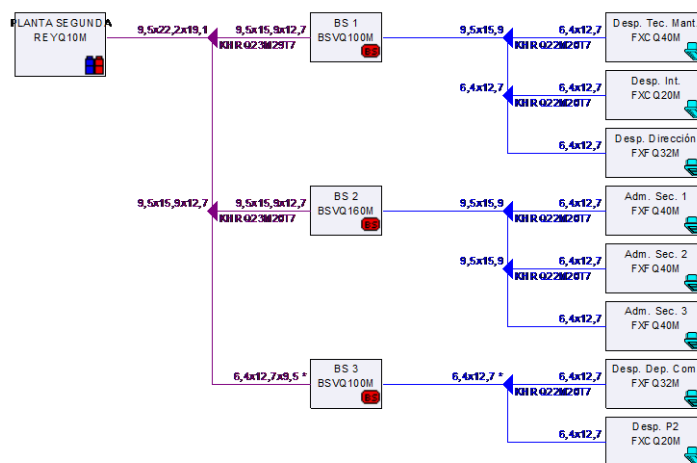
Esquema conexión de tuberías frigoríficas VRV. PLANTA SEGUNDA
